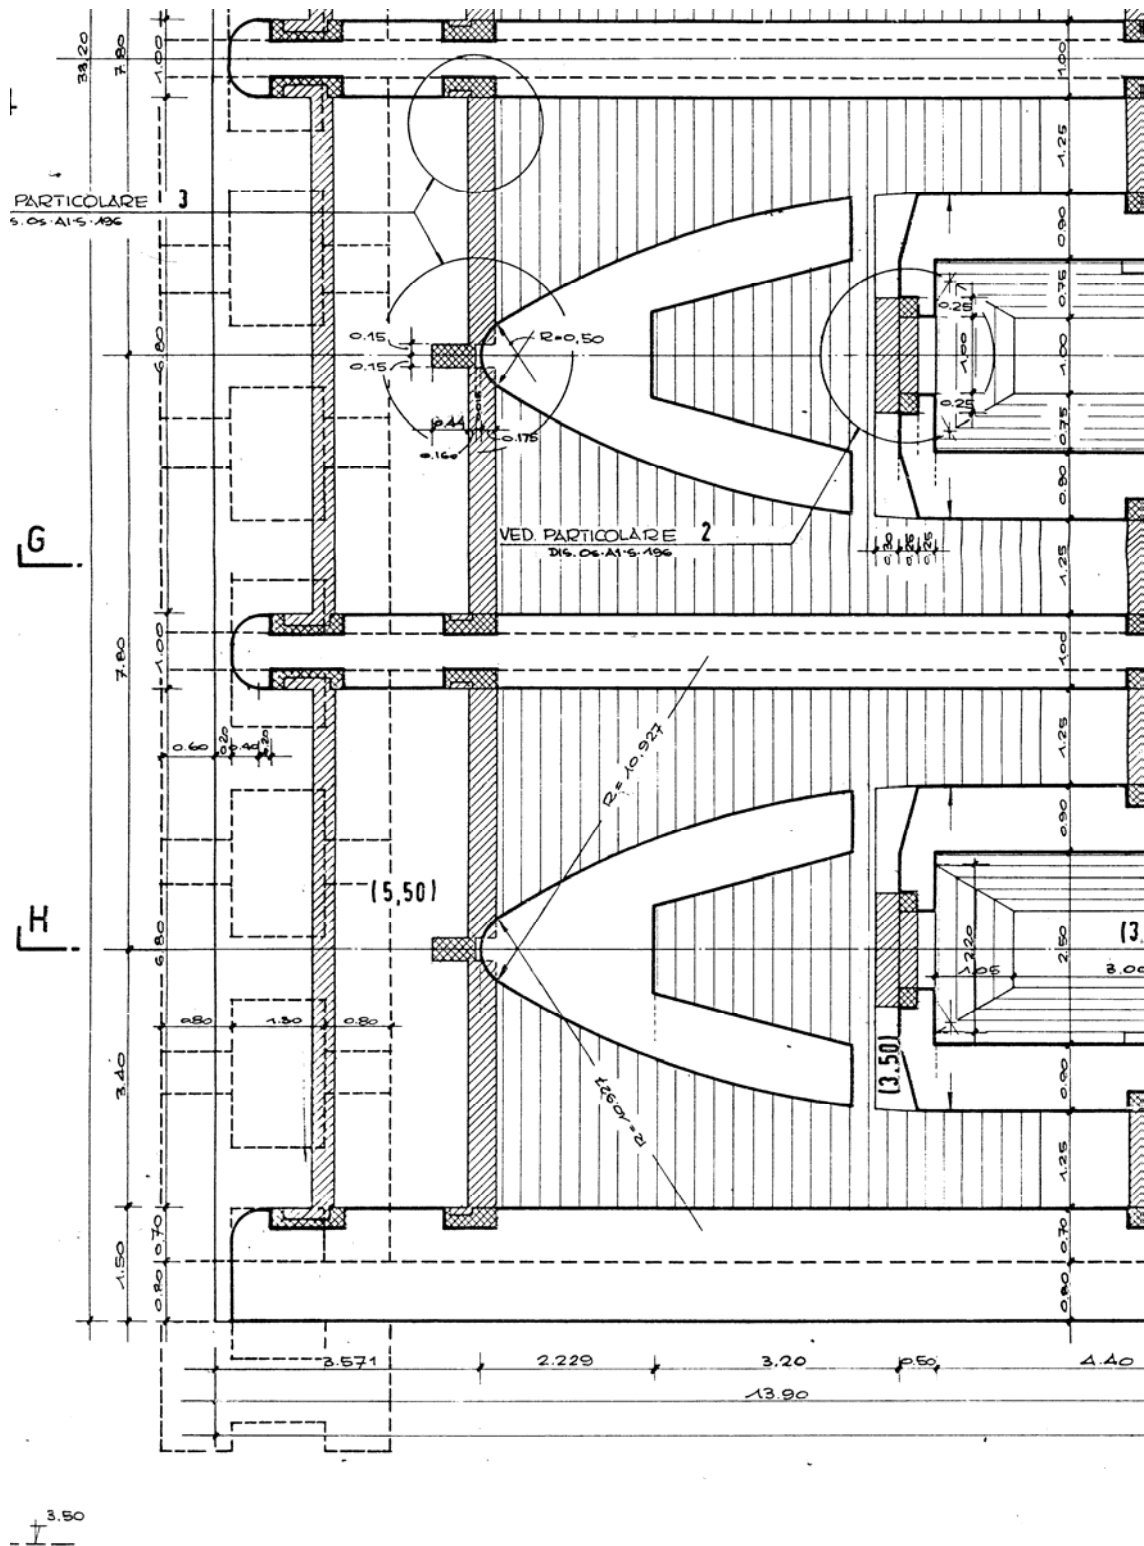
Sezione in pianta dell'opera di presa nella zona di aspirazione (particolare)
